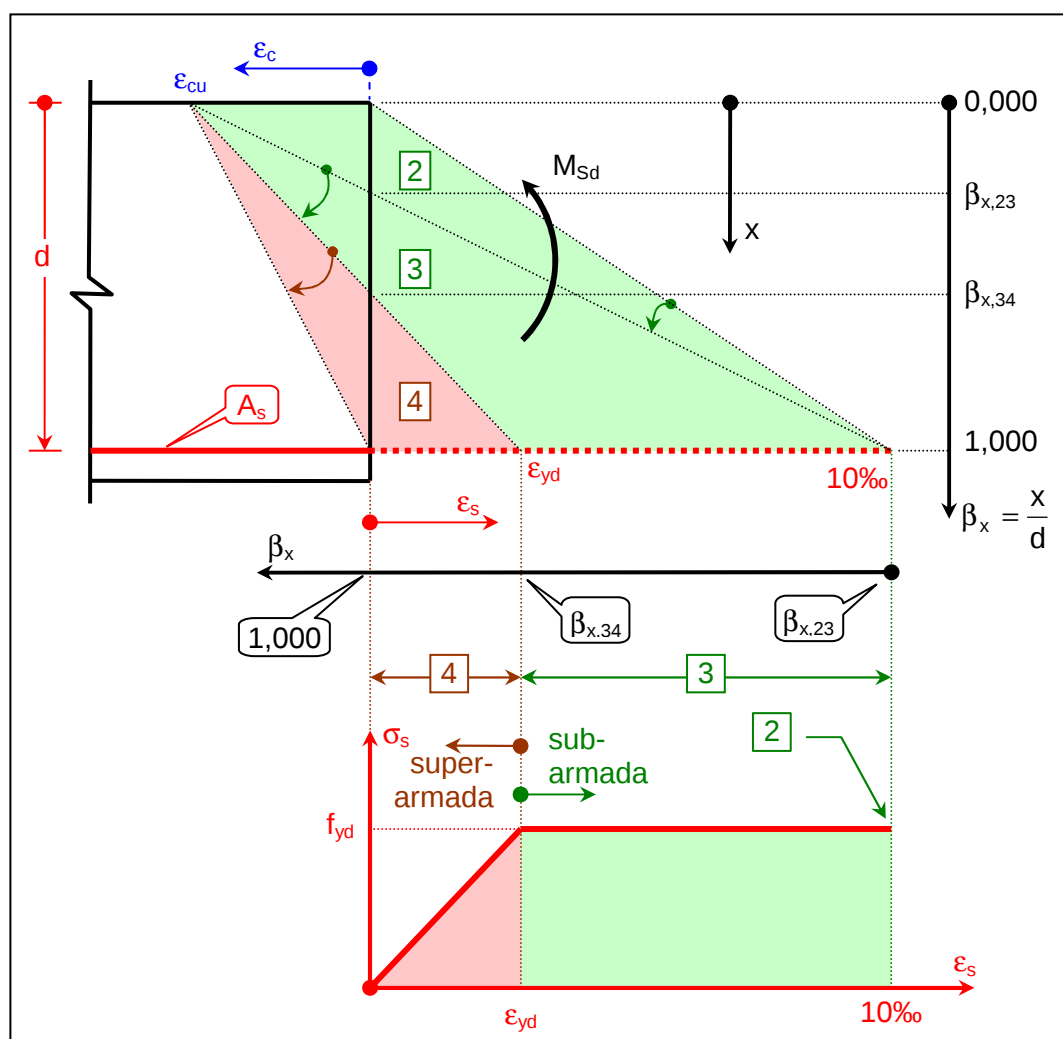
Domínios possíveis para vigas de concreto armado
